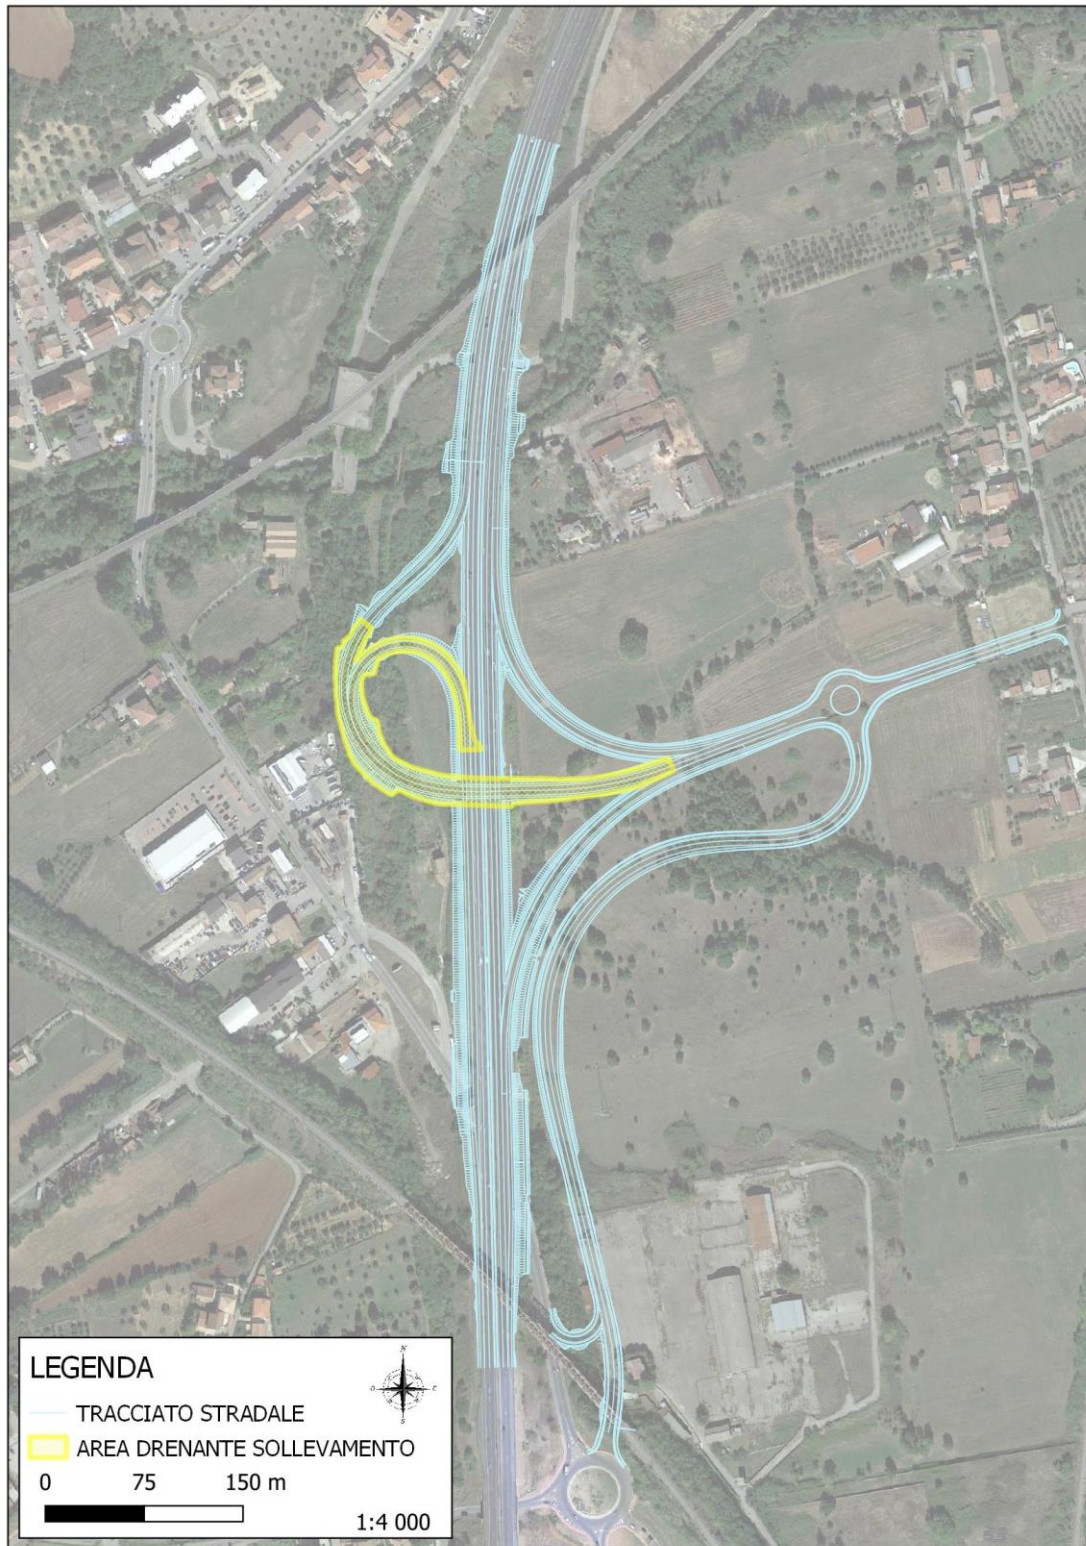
planimetria individuazione area drenante in corrispondenza del sollevamento
